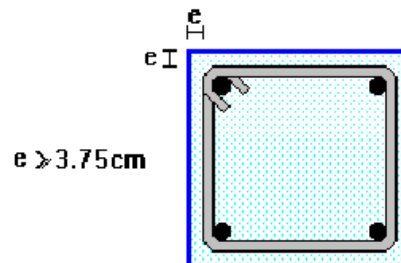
Recubrimiento mínimo de hormigones fundidos en sitio.
